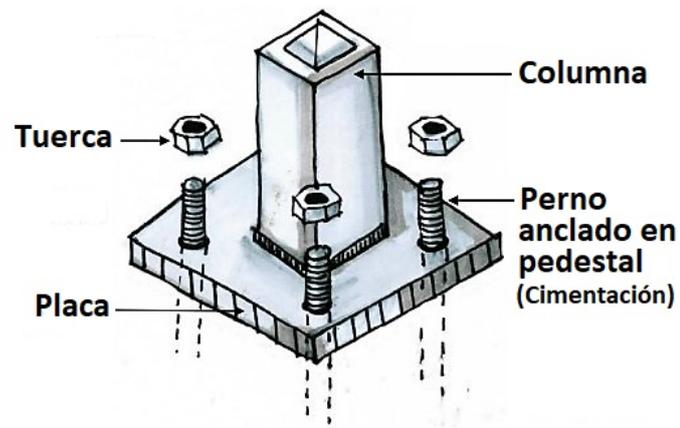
Conexión de columna metálica con anclajes. Fuente: Martínez (2014)
